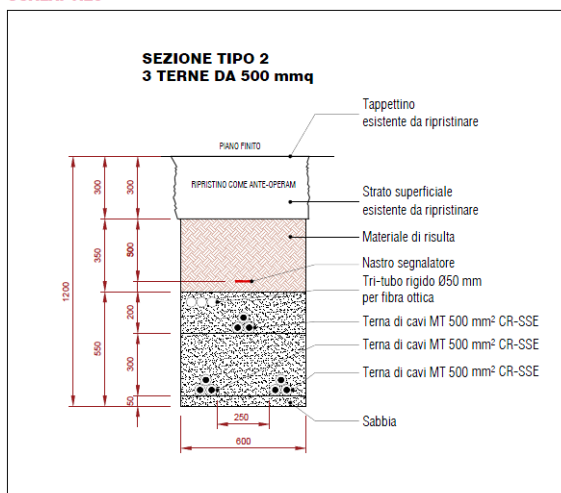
Sezioni tipo di scavo per cavidotto collegamento CR – SSE Utente
